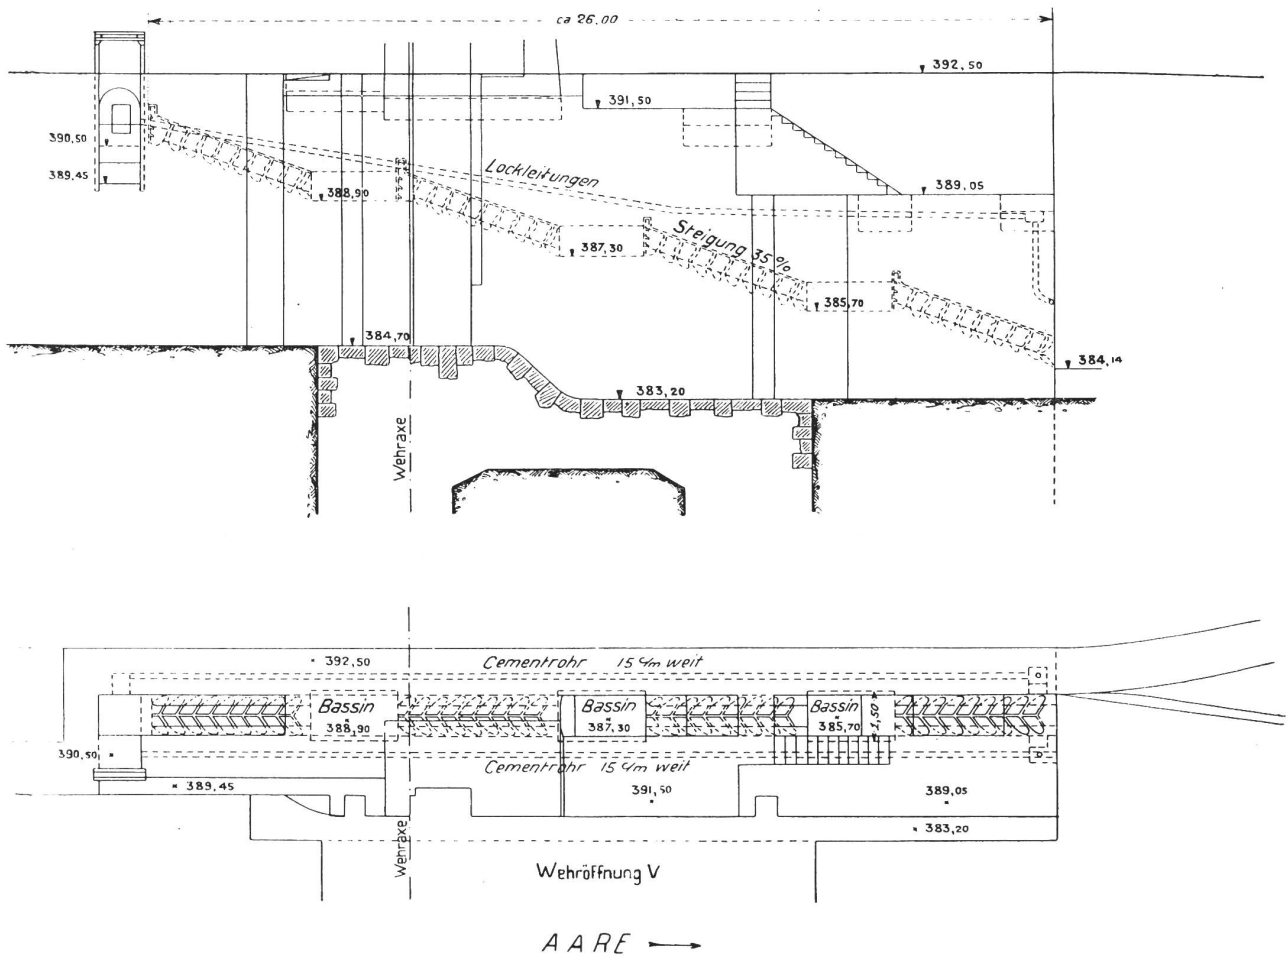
Stauwehr des Elektrizitätswerkes Olten-Gösgen. Grundriss und Längsschnitt durch die Denil-Fischstreppe. Maßstab 1 : 200.
